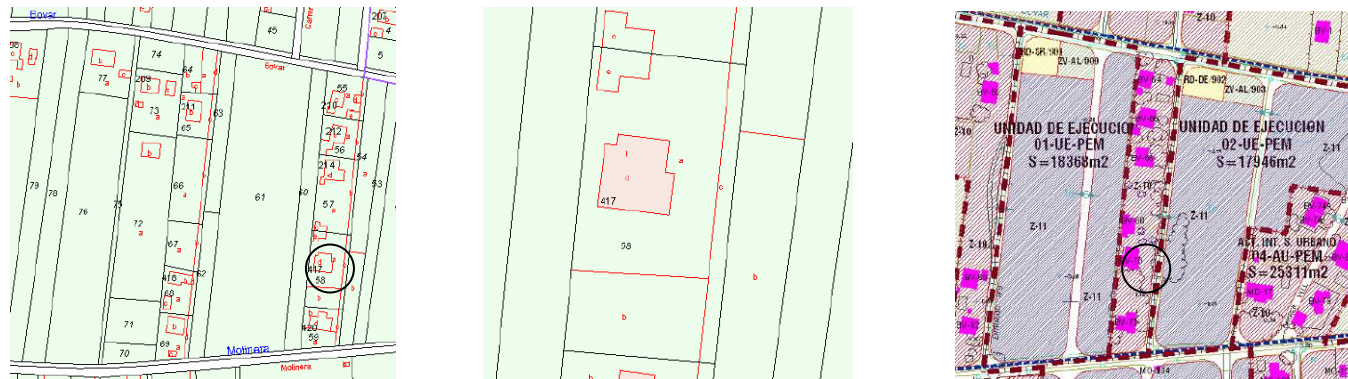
Planos de situación, emplazamiento y urbanístico de la vivienda.
